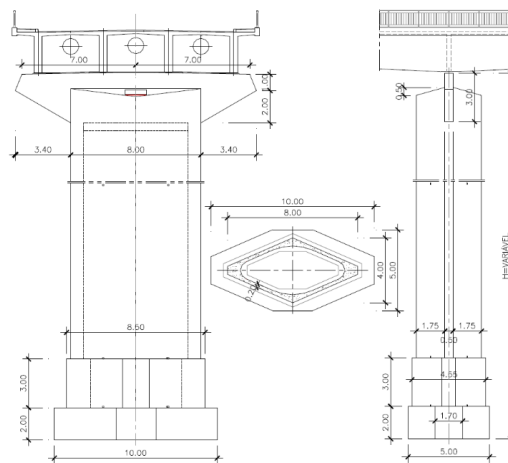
Dimensões dos pilares da ponte da Foz do Dão.
